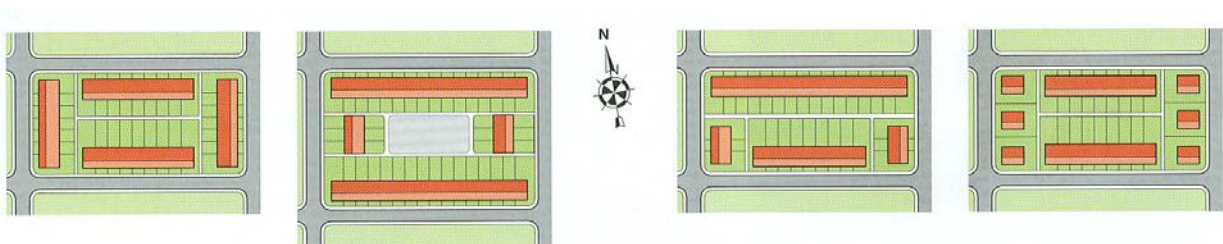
voorbeeld van zongerichte verkaveling in een gevarieerd plan – Vathorst, Amersfoort
